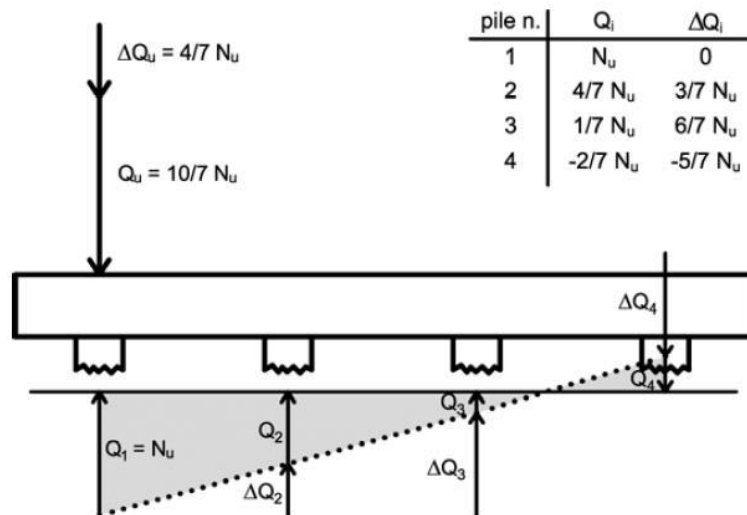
Fondazione su 4 pali soggetta a carichi verticale ed eccentrici (Di Laora et al., 2019).
